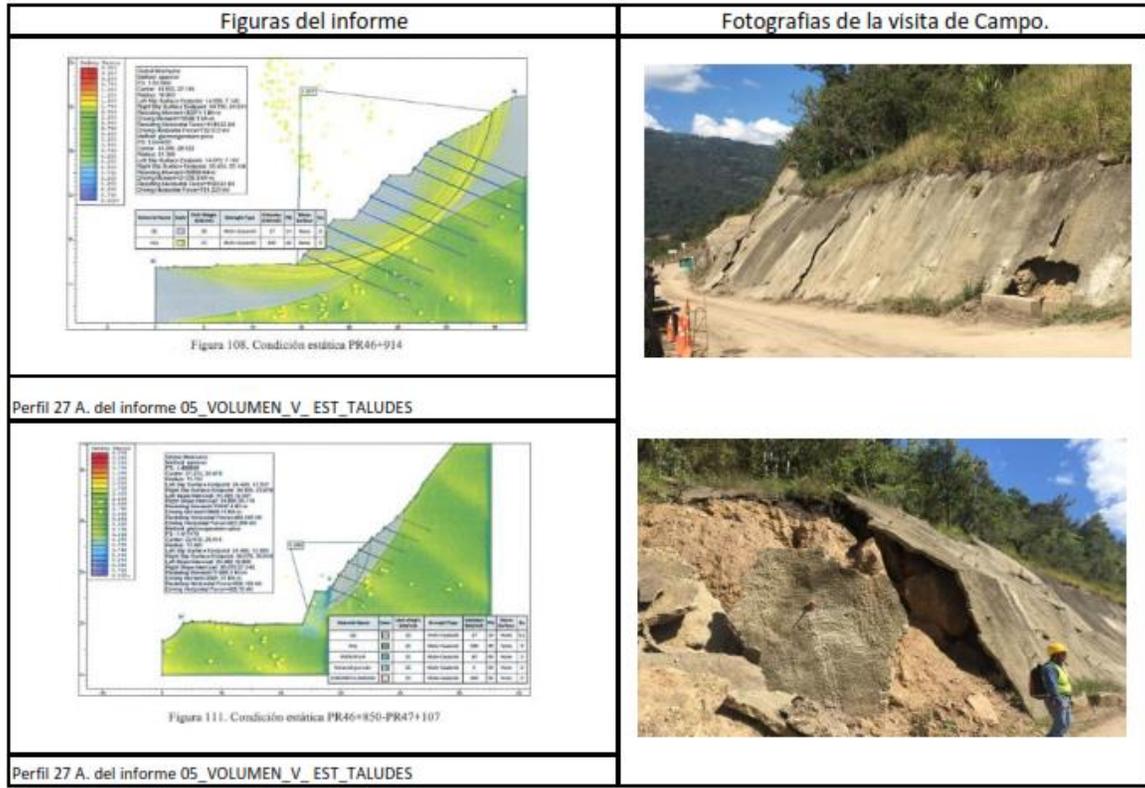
Comparación entre las secciones analizadas y las secciones construidas.
